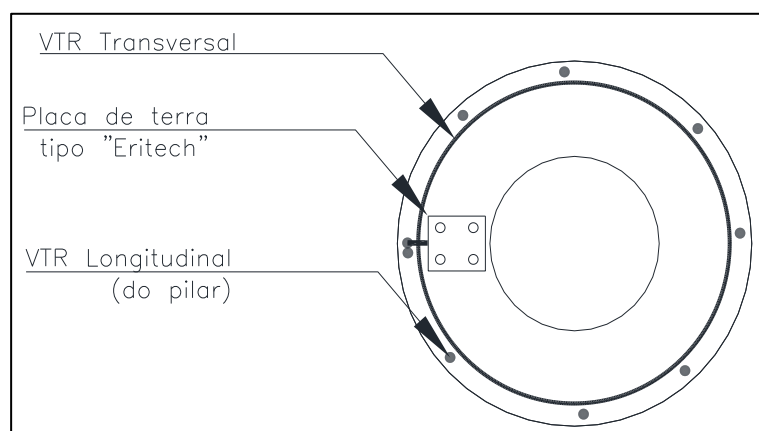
Desenho de princípio da ligação das armaduras nos pilares
